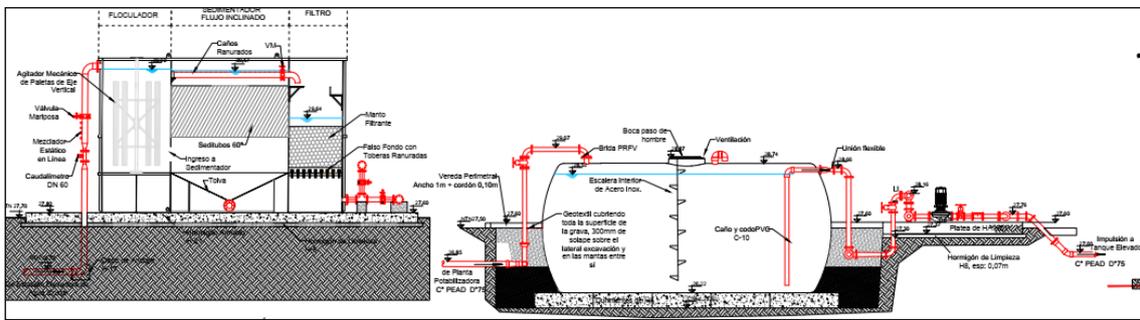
Esquema de la Planta Potabilizadora a ejecutar.
